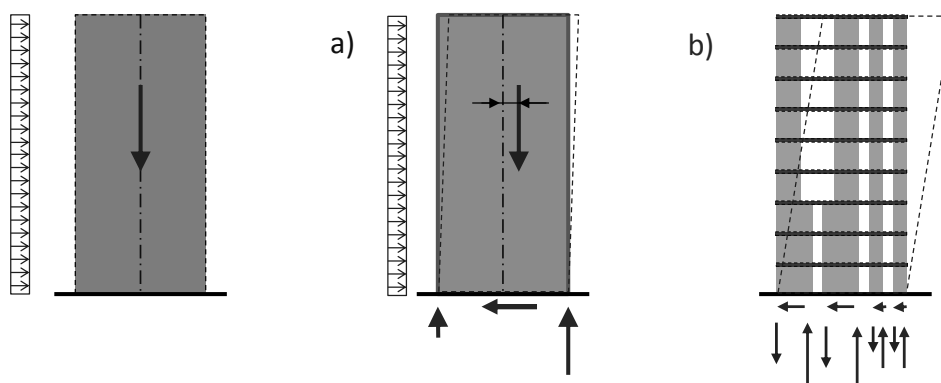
a) struttura monolitica con collegamenti rigidi b) struttura in XLAM con collegamenti non infinitamente rigidi
